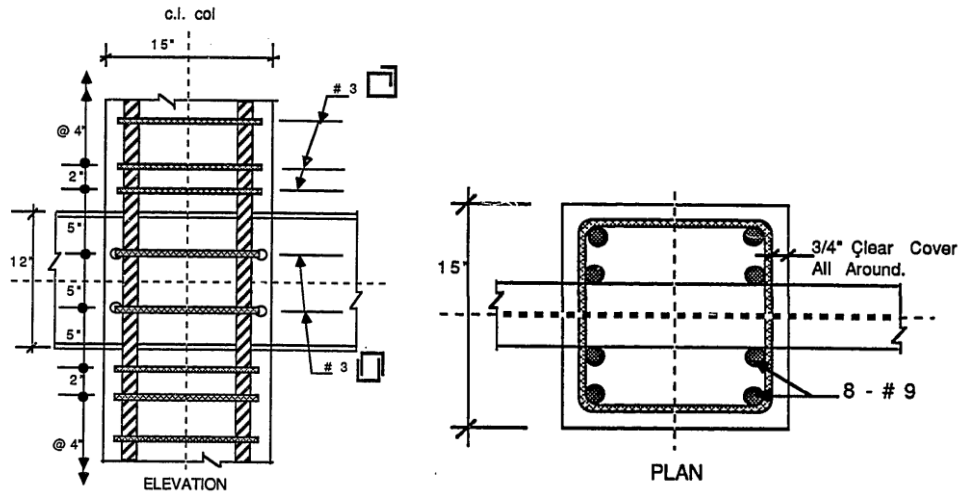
Detalles del refuerzo en la junta para el grupo 1 en vista de corte y vista de planta. Nota. Shikh muhammad t. moment connections between steel beams and concrete columns (1987) (pág.50)
